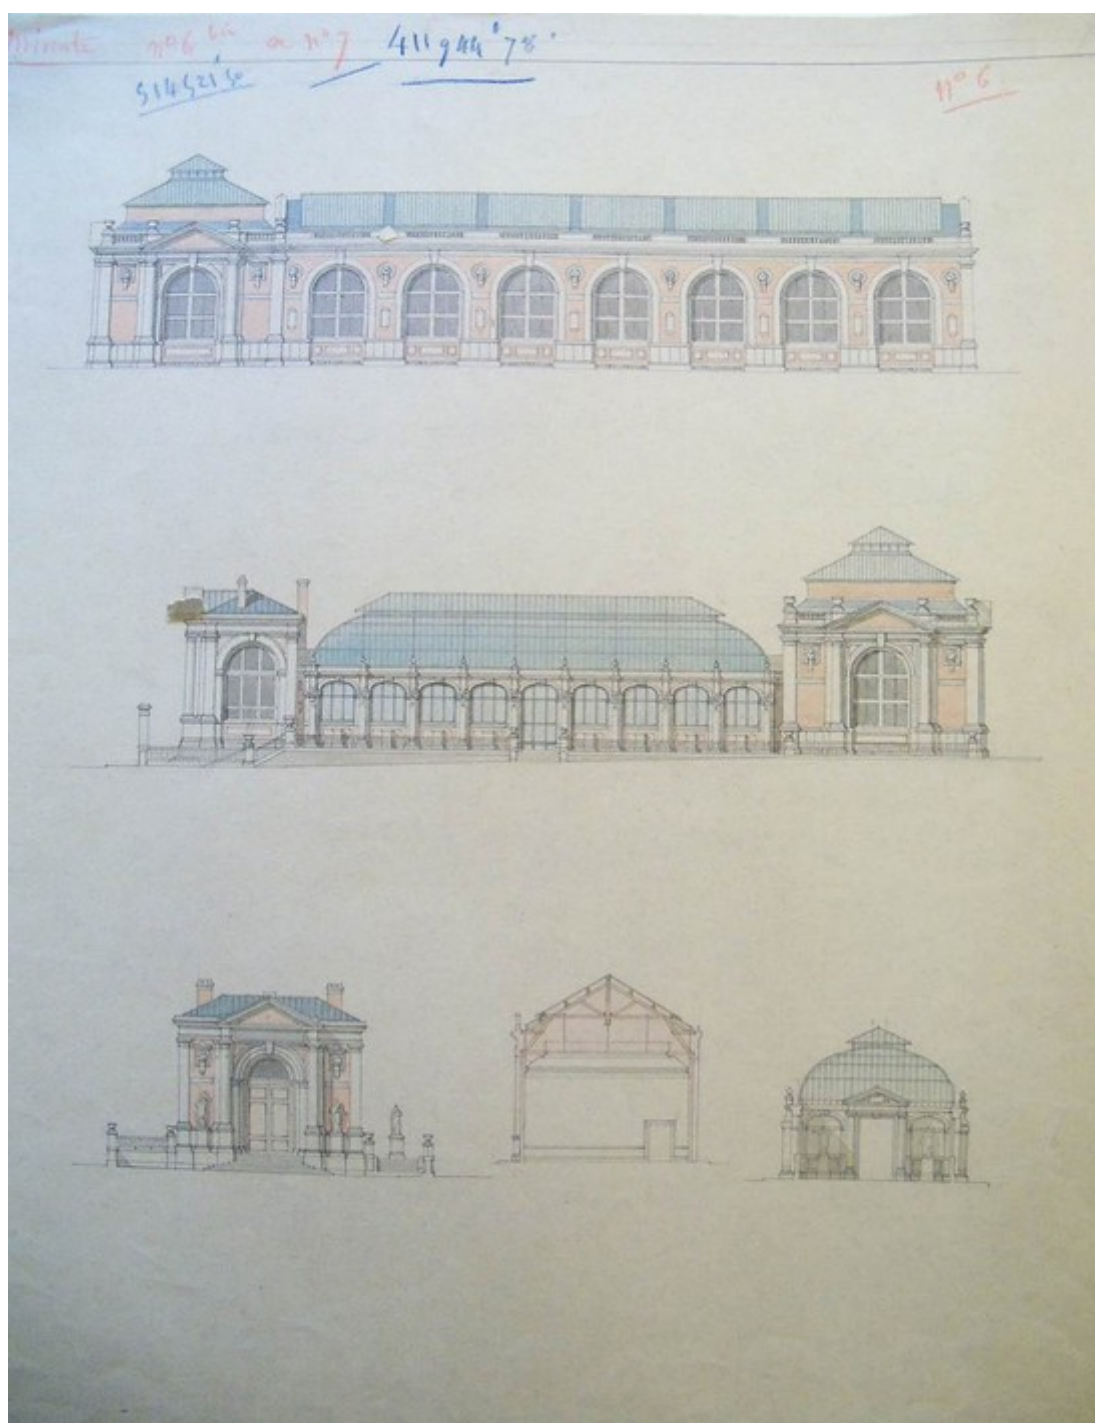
Charles Gondoin, [Elévations de la façade sud de l'orangerie prolongée, de la façade ouest de l'extension, de la façade nord du pavillon d'entrée, et coupes transversales sur l'orangerie et la galerie de sculpture], s.d. [février 1884] (Sénat/DAPJ, n°1226, cote provisoire).
